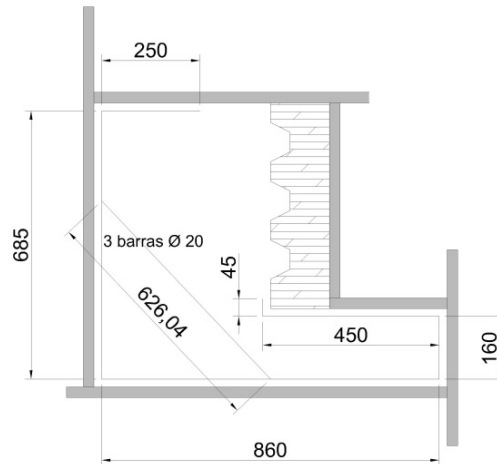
Disposición del encofrado para la fabricación de las piezas de hormigón para tres llaves (mm)
